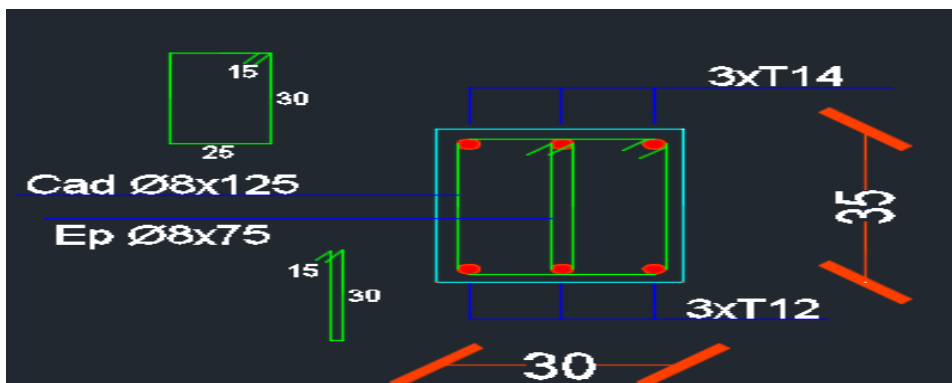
Ferrailage des poutres secondaires au niveau de travée
